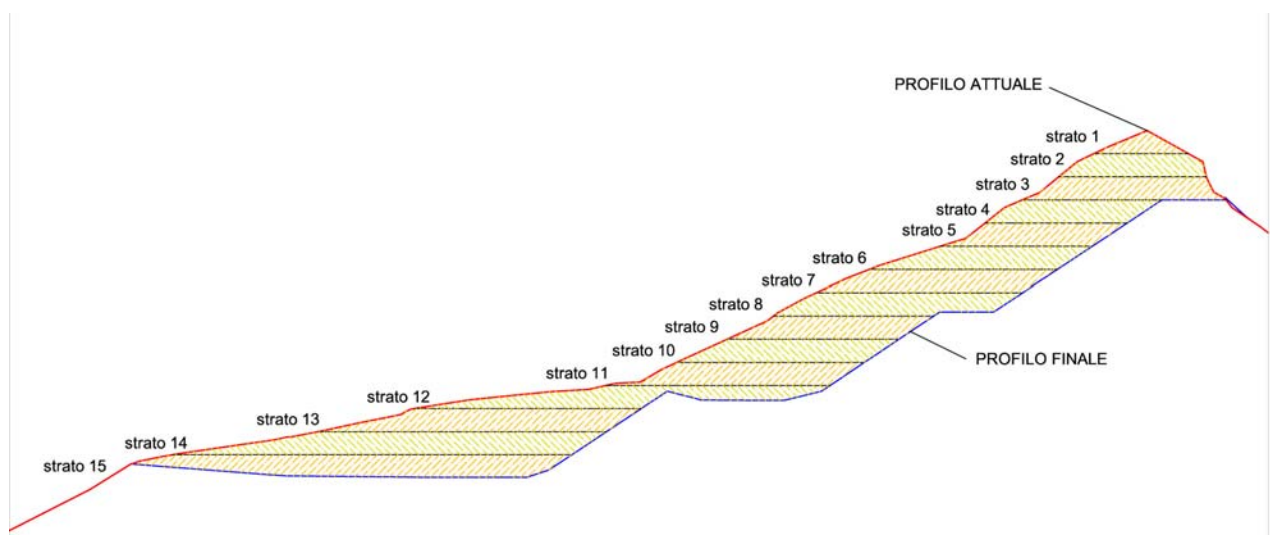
Schema di conduzione degli scavi (a strati successivi)
